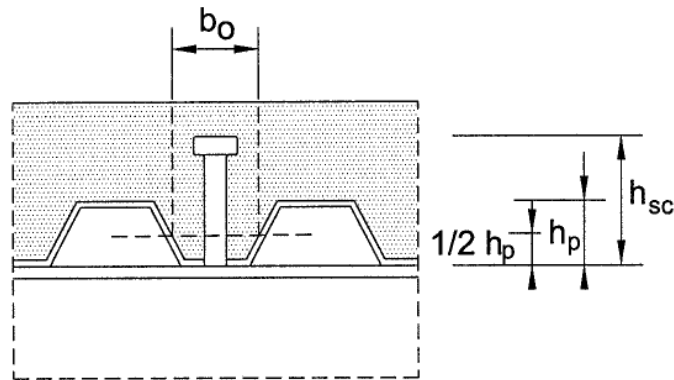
Viga com chapas perfiladas de aço transversais à viga
